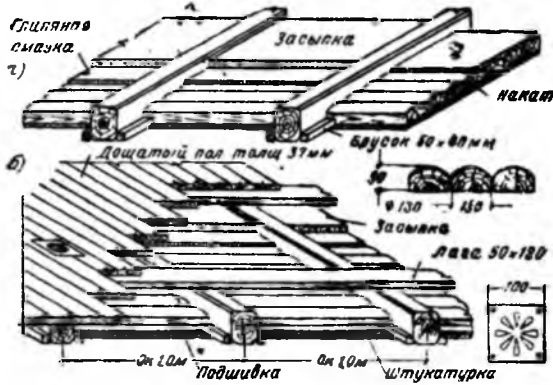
Конструкция верхних и нижних перекрытий по балкам
